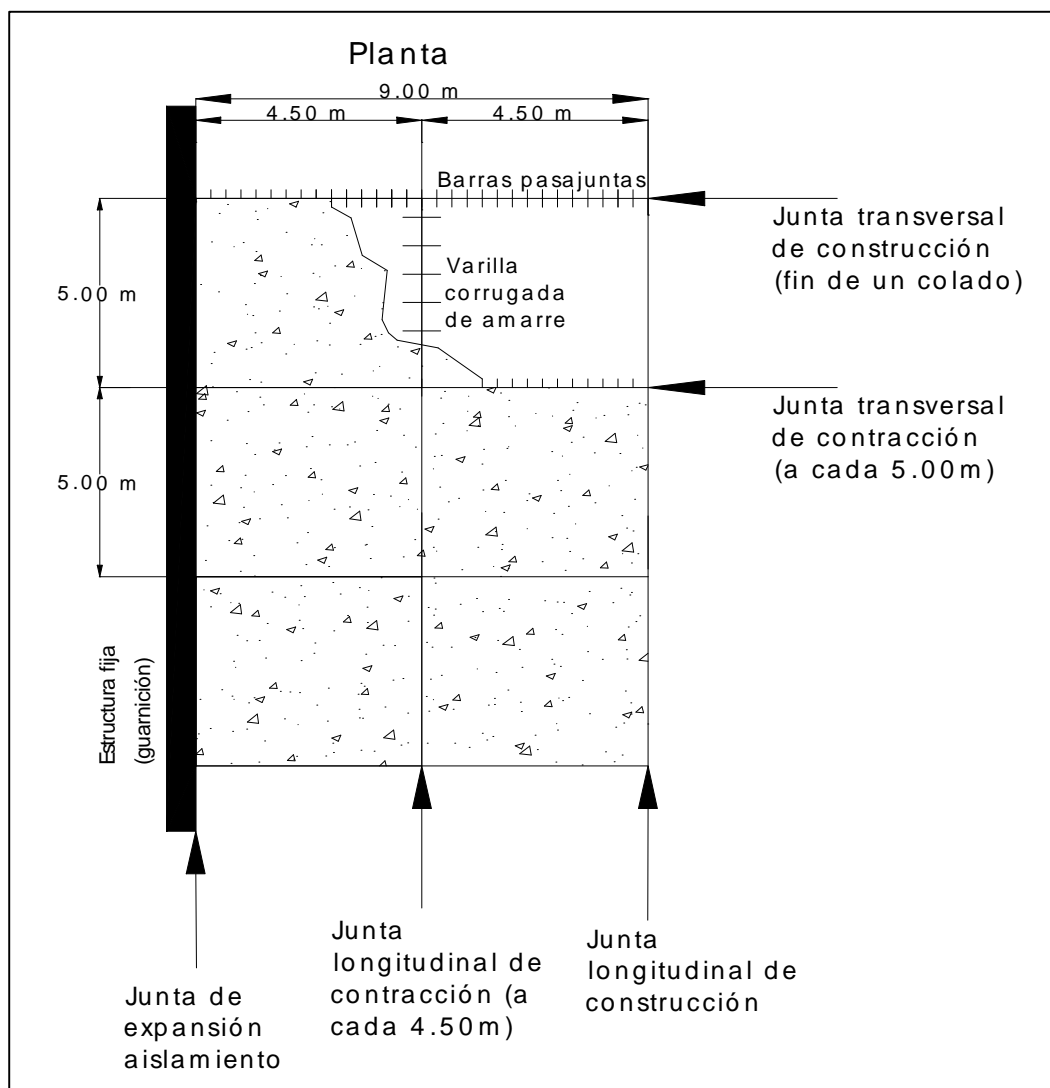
Tipos de juntas que existen en un pavimento de concreto.
